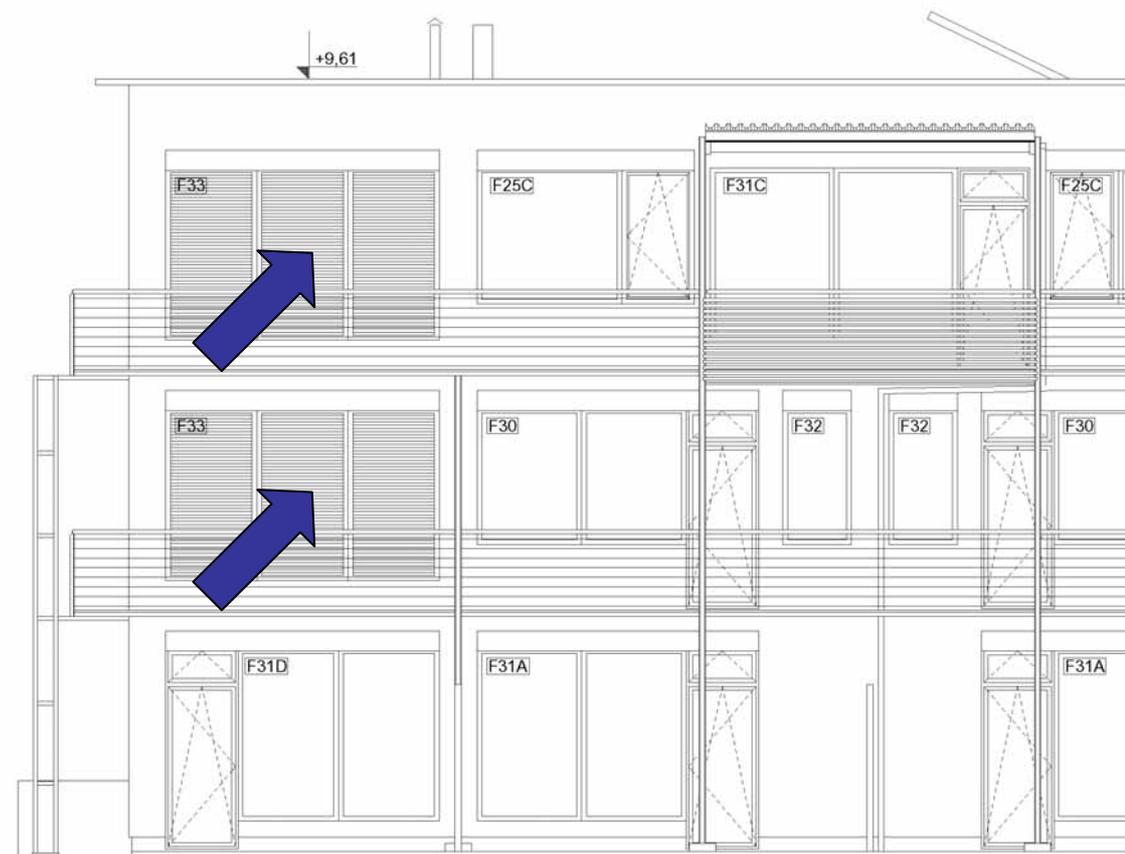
Ansicht Südwestfassade Haus 3 mit Jalousien im Wärmeschutzglas (blaue Pfeile)
